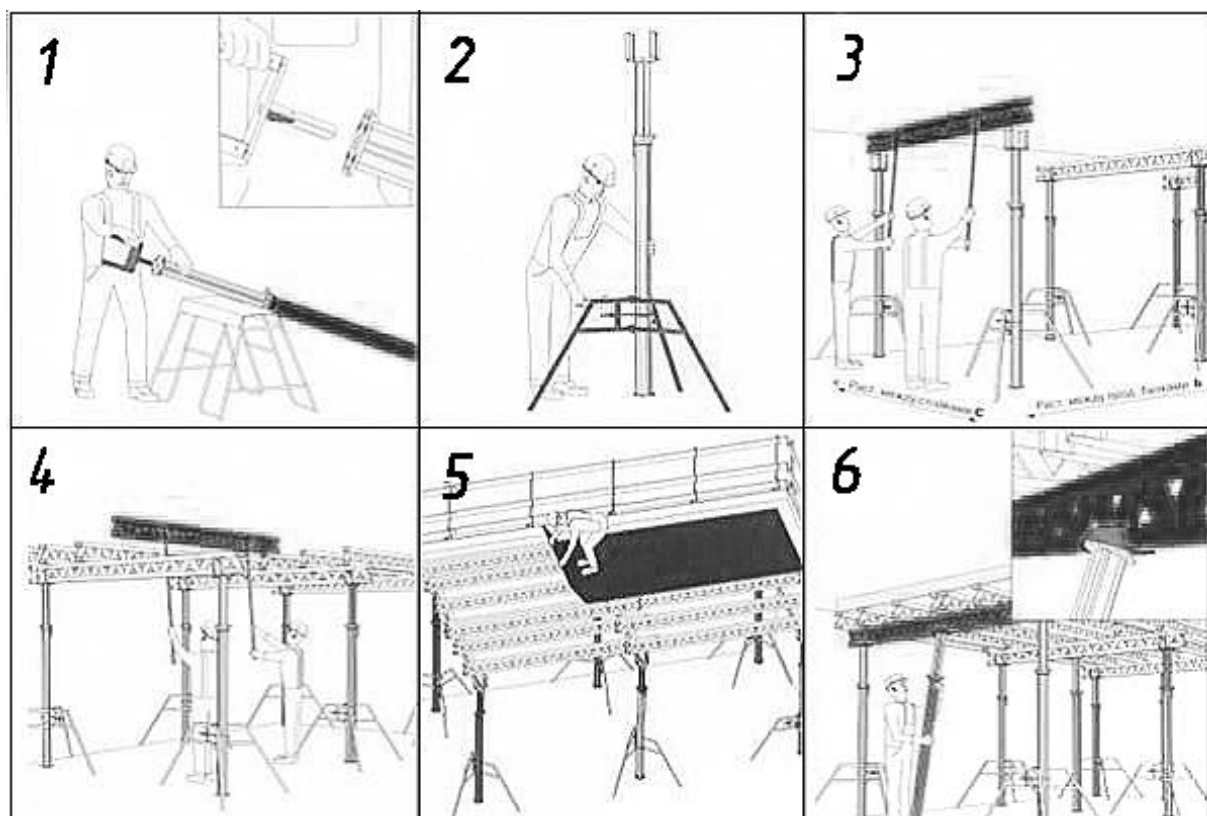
Порядок установки опалубки перекрытия: 1 – установка кре-стовой головки; 2 – установка стойки; 3 – установка продольных балок; 4 установка поперечных балок; 5 – укладка щитов фанеры; 6 – установка про-межуточных опор.
